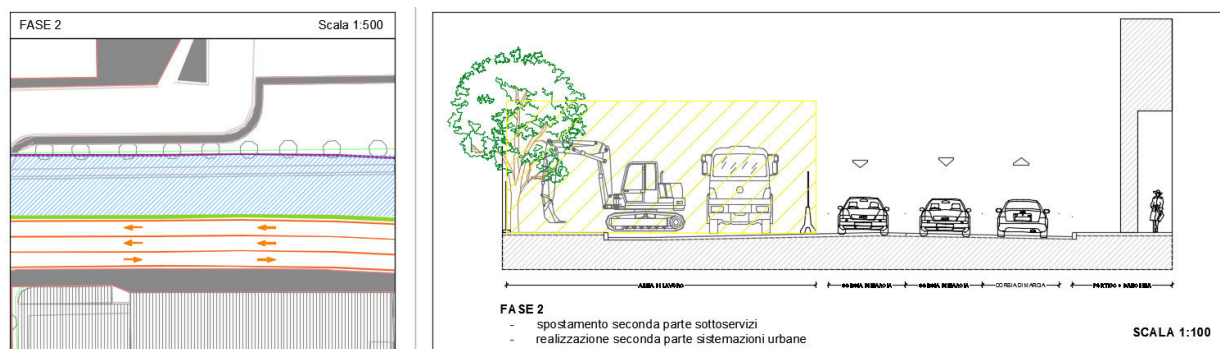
Tipologico cantiere con sede centrale Fase 2
